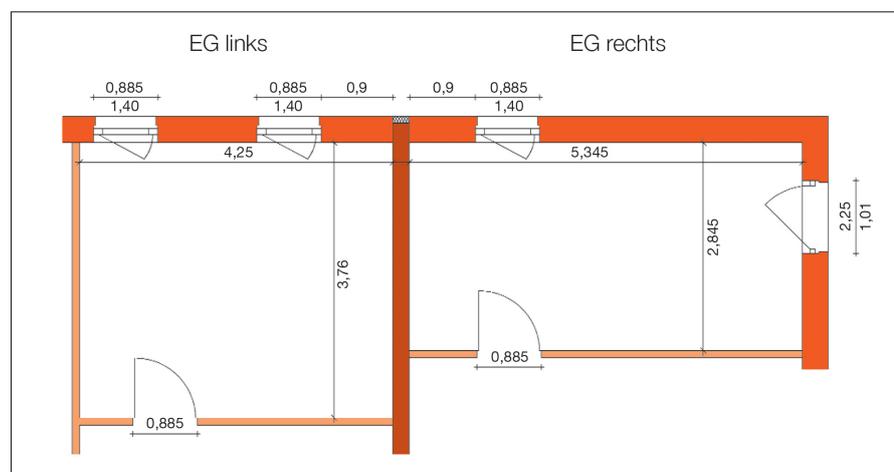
Grundriss zweier nebeneinander liegender Wohnräume.
